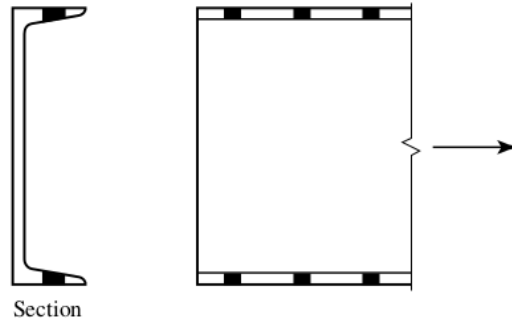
Perfil C tracionado conectado pelas mesas.
